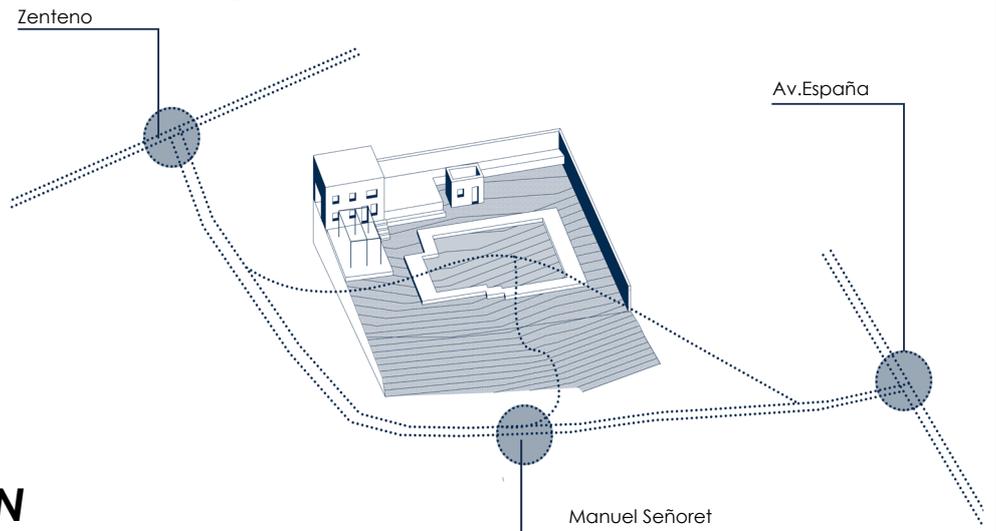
Propuesta Plan Maestro Cicloruta 60k. Fuente: Elaboración propia en base a planos de propuesta existentes.
